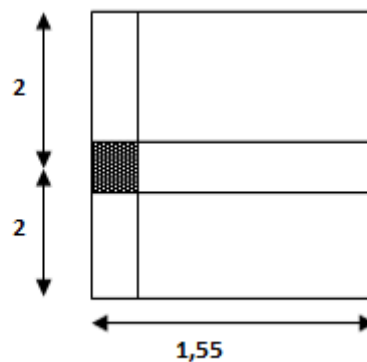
Surface du plancher revenant au poteau de rive le plus sollicité.
